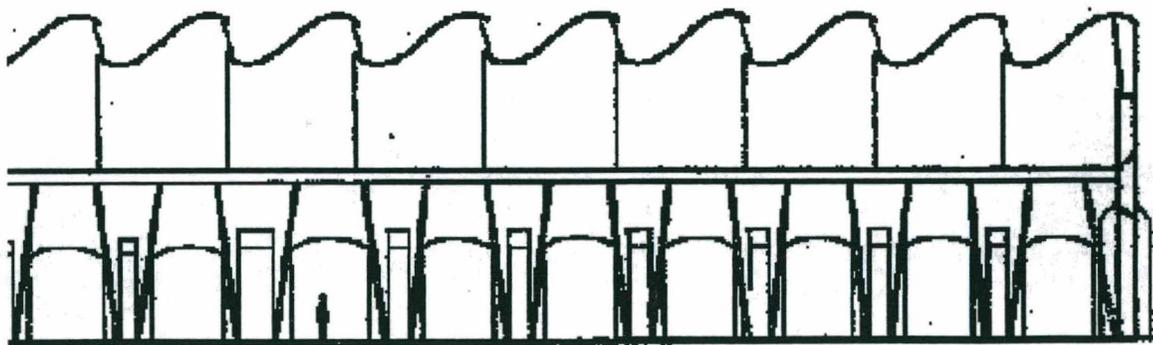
Corte longitudinal do Depósito J.H.O. na Espanha (PEDRESCHI, 1996).
